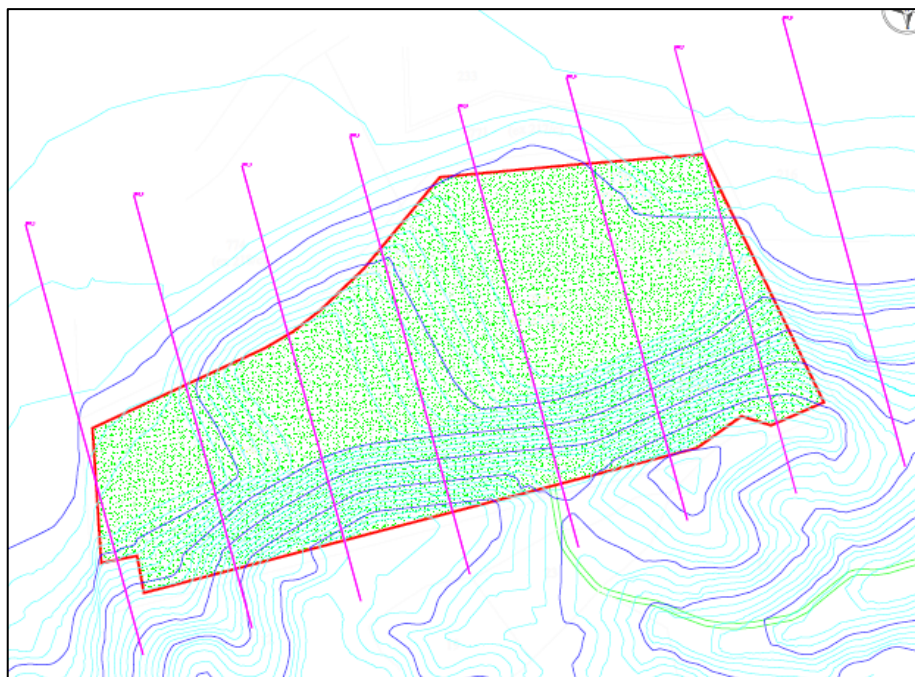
Schema rappresentante la planimetria della fase di ripristino
